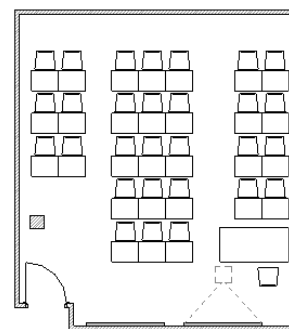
Planta del aula habitual. Fuente: Elaboración propia
